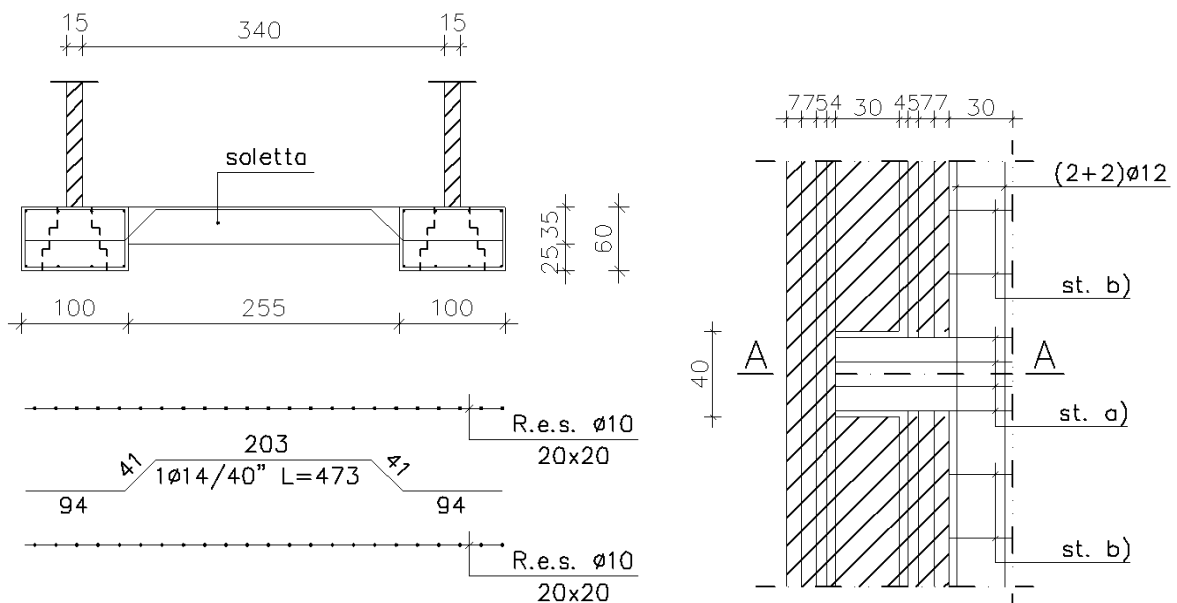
Ex-Lavanderie - stato di progetto: sezione 2-2 e particolare "A".
